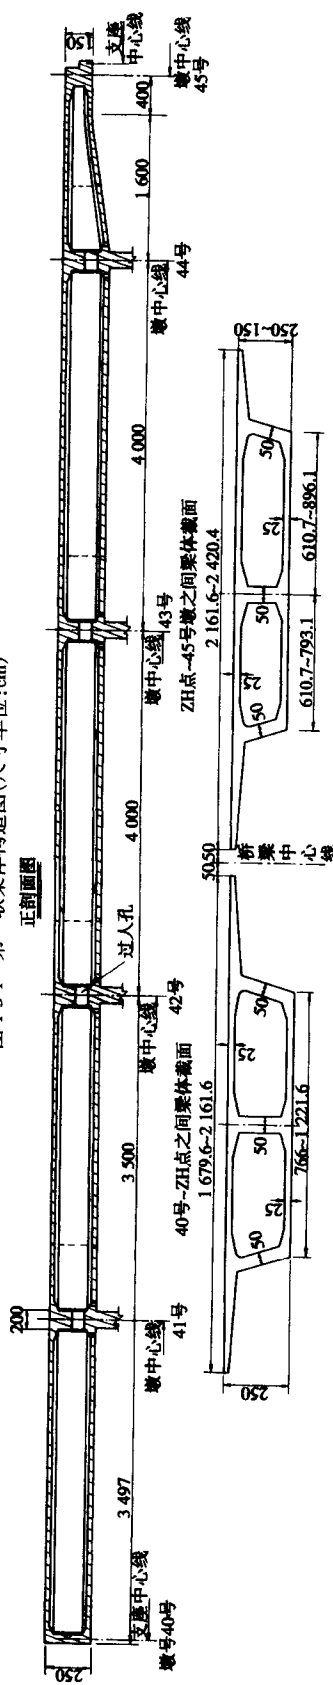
第二联梁体构造图(尺寸单位:cm)
